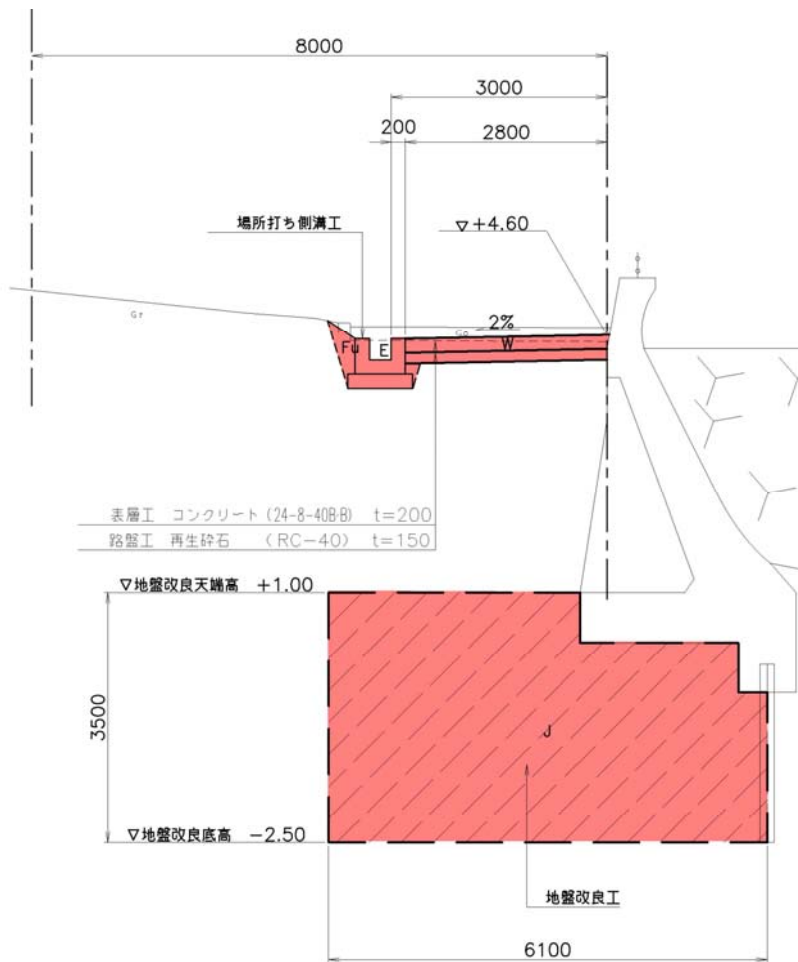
施工事例 地盤改良工標準断面図 (石川海岸・浜佐美)
